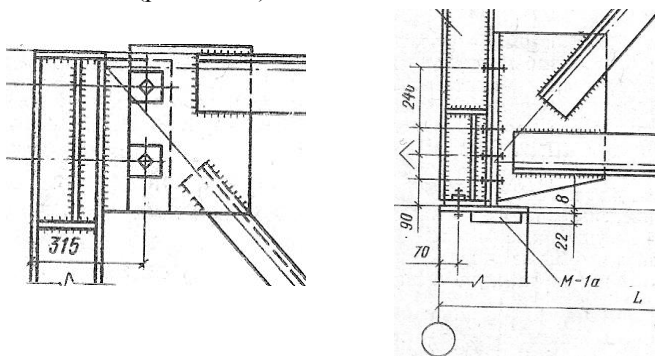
Опираие стальной фермы на железобетонную колонну
